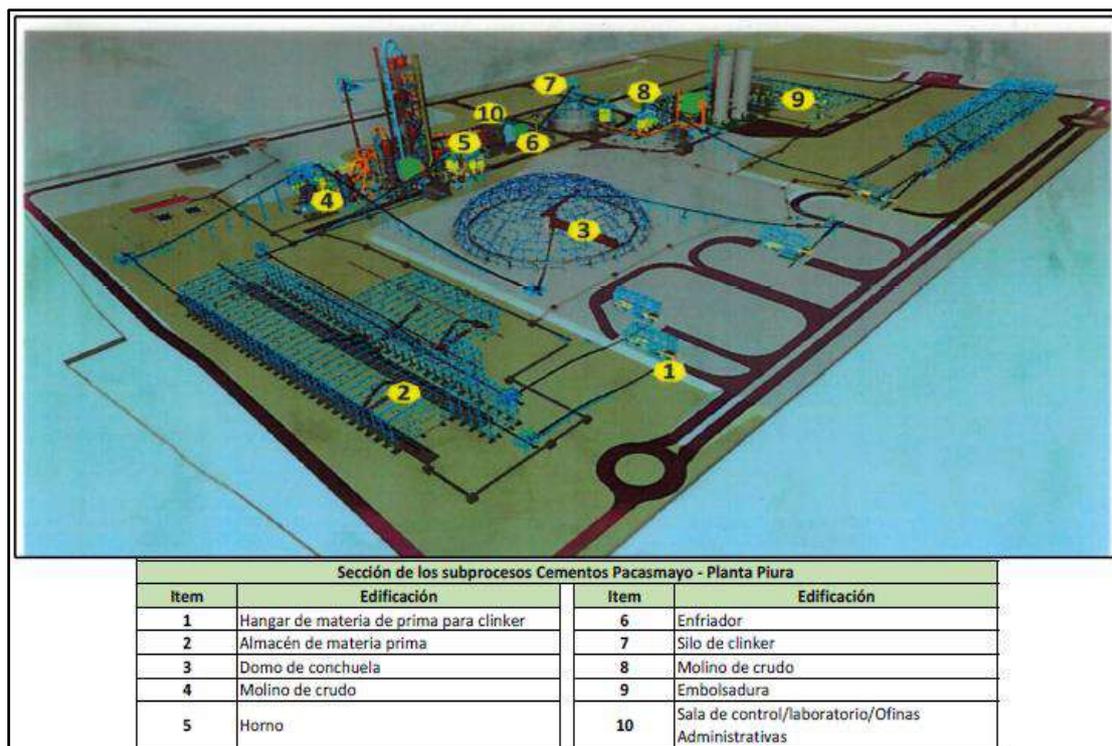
Plano de la Planta de Cementos Piura y sus subprocesos
